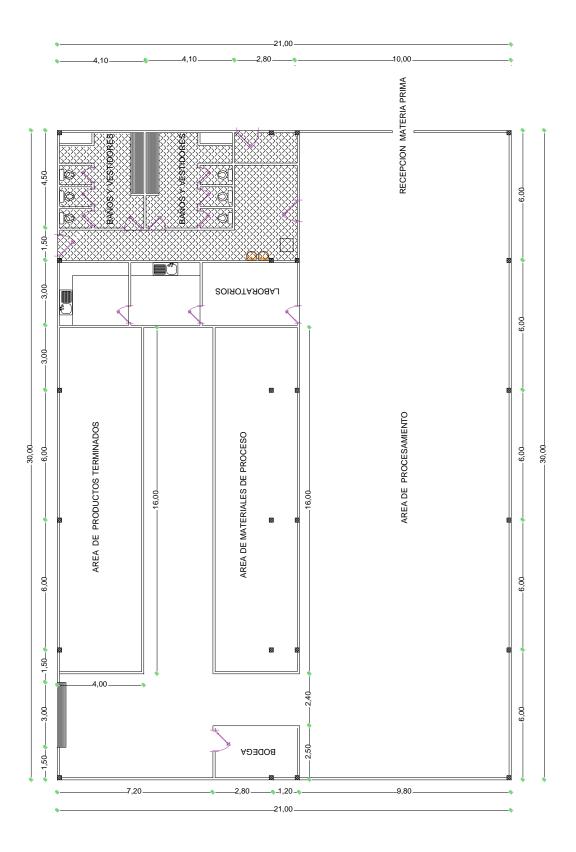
Diseño de planta industrial Esc. 1:100.
